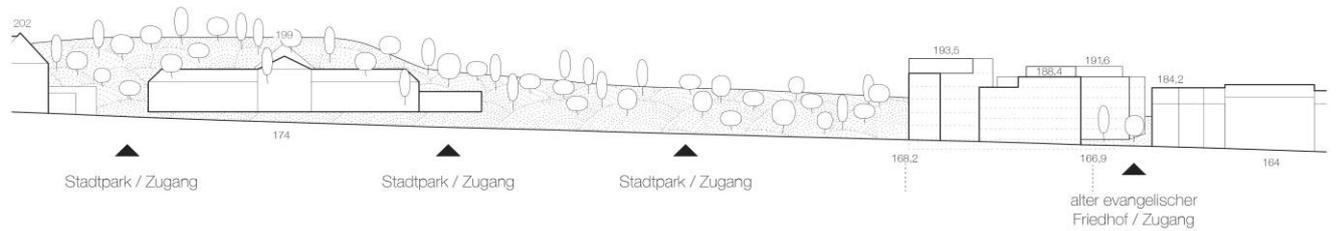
städtebauliche Lage an der Monheimsallee – Planung
